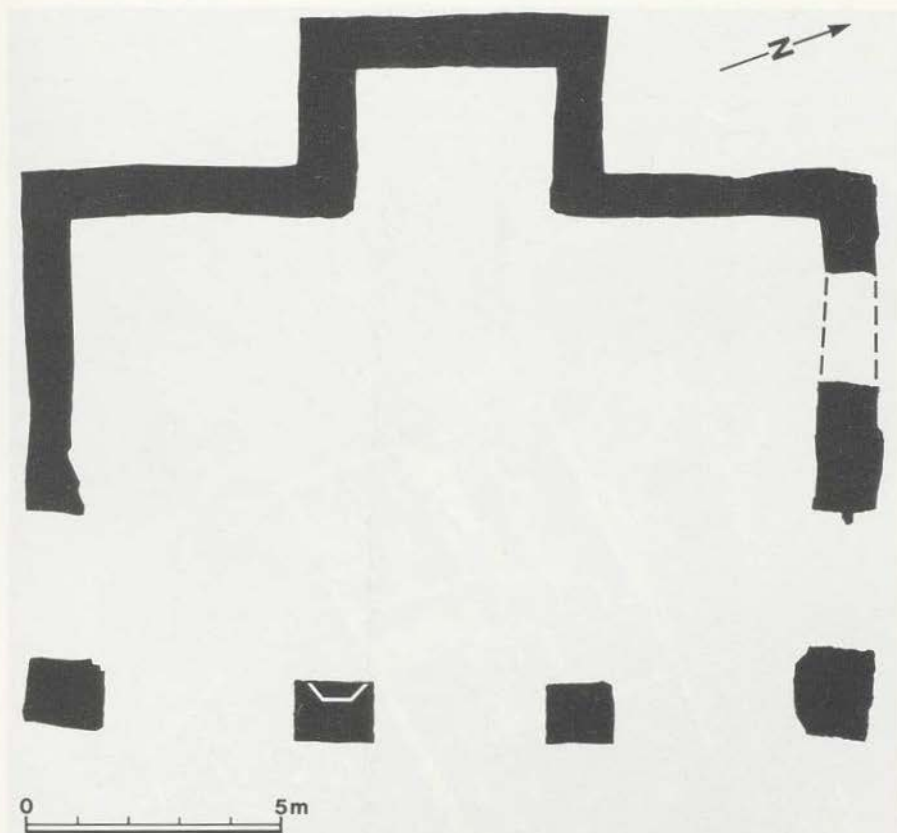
Walheim a. N. Grundriß von Gebäude 22.
